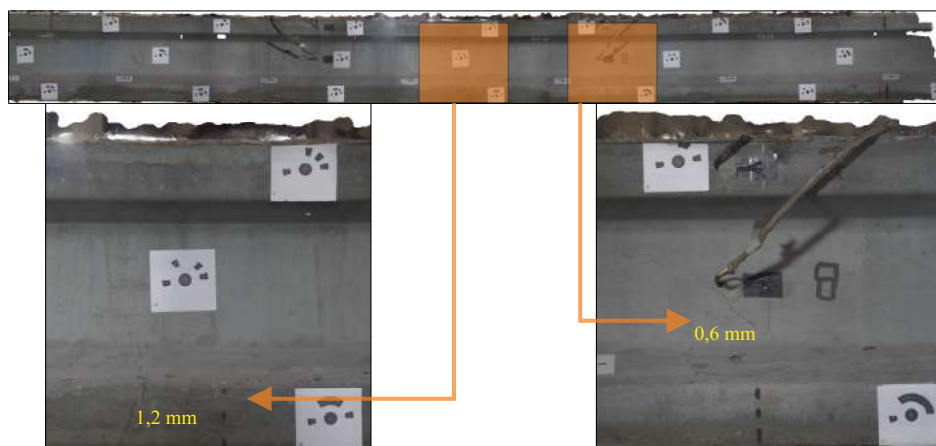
Fissuração máxima no 4<sup>o</sup> Ciclo - Viga UHPFRC (V03)
